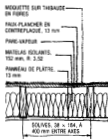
ISOLATION DES PLANCHERS AU-DESSUS D'UN VIDE SANITAIRE NON CHAUFFÉ
